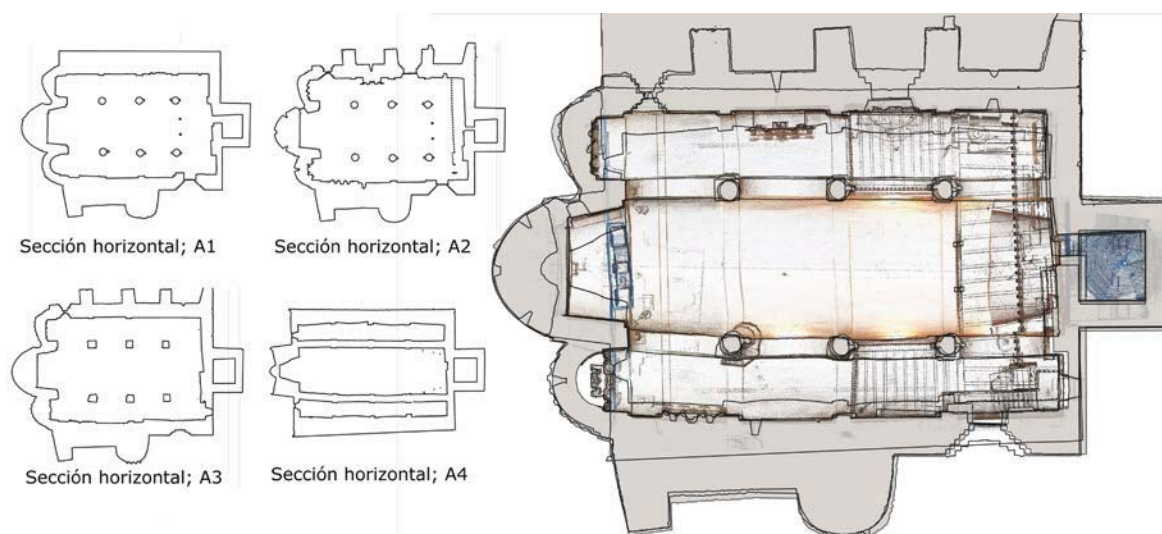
Estudio de deformación de la planta de Santa María d'Arties.
